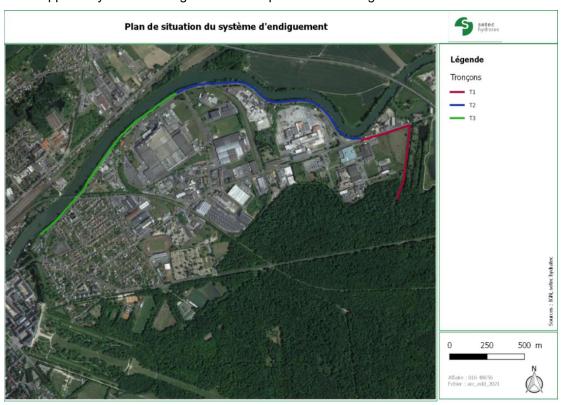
Plan du système d'endiguement ZI Nord de Compiègne
